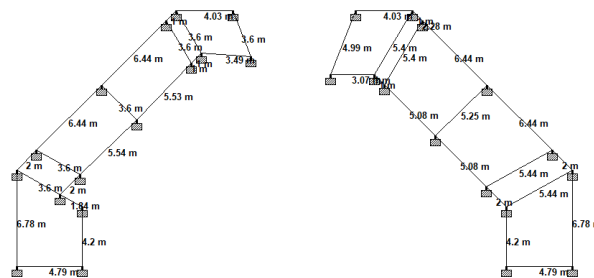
Vista en Planta de la Estructura con Dimensiones
